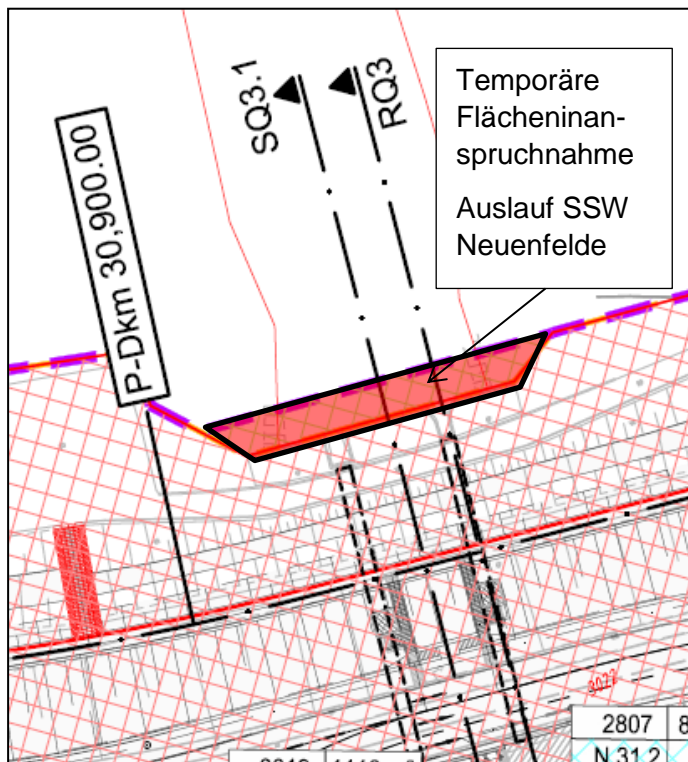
Ausschnitt aus Lageplan „Flächenbedarfsplan PFU 06_N_1“. Quelle: WKC
